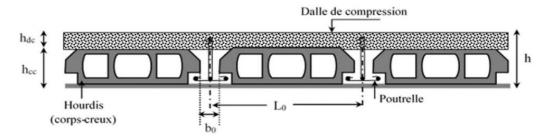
Coupe transversale d'un plancher à corps creux.
